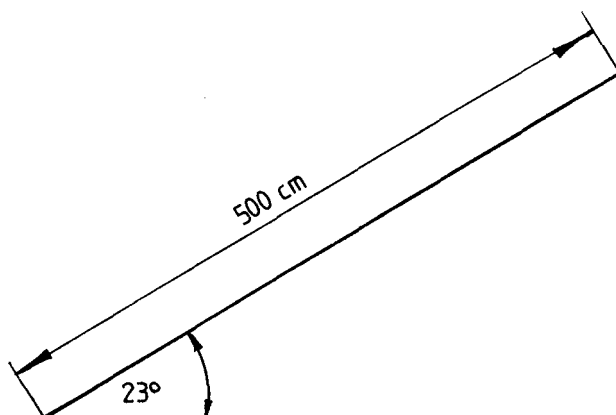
Dimensionamiento de la cubierta.
